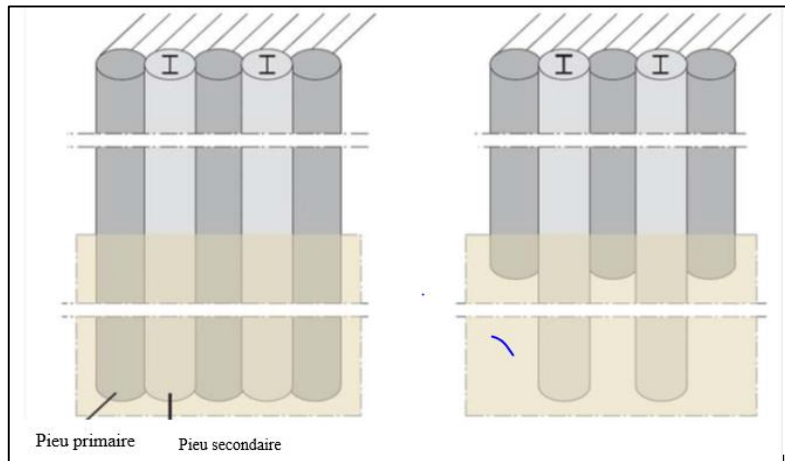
Mur de pieux sécants classiques (à gauche) et en touches de piano (à droite) [4]
